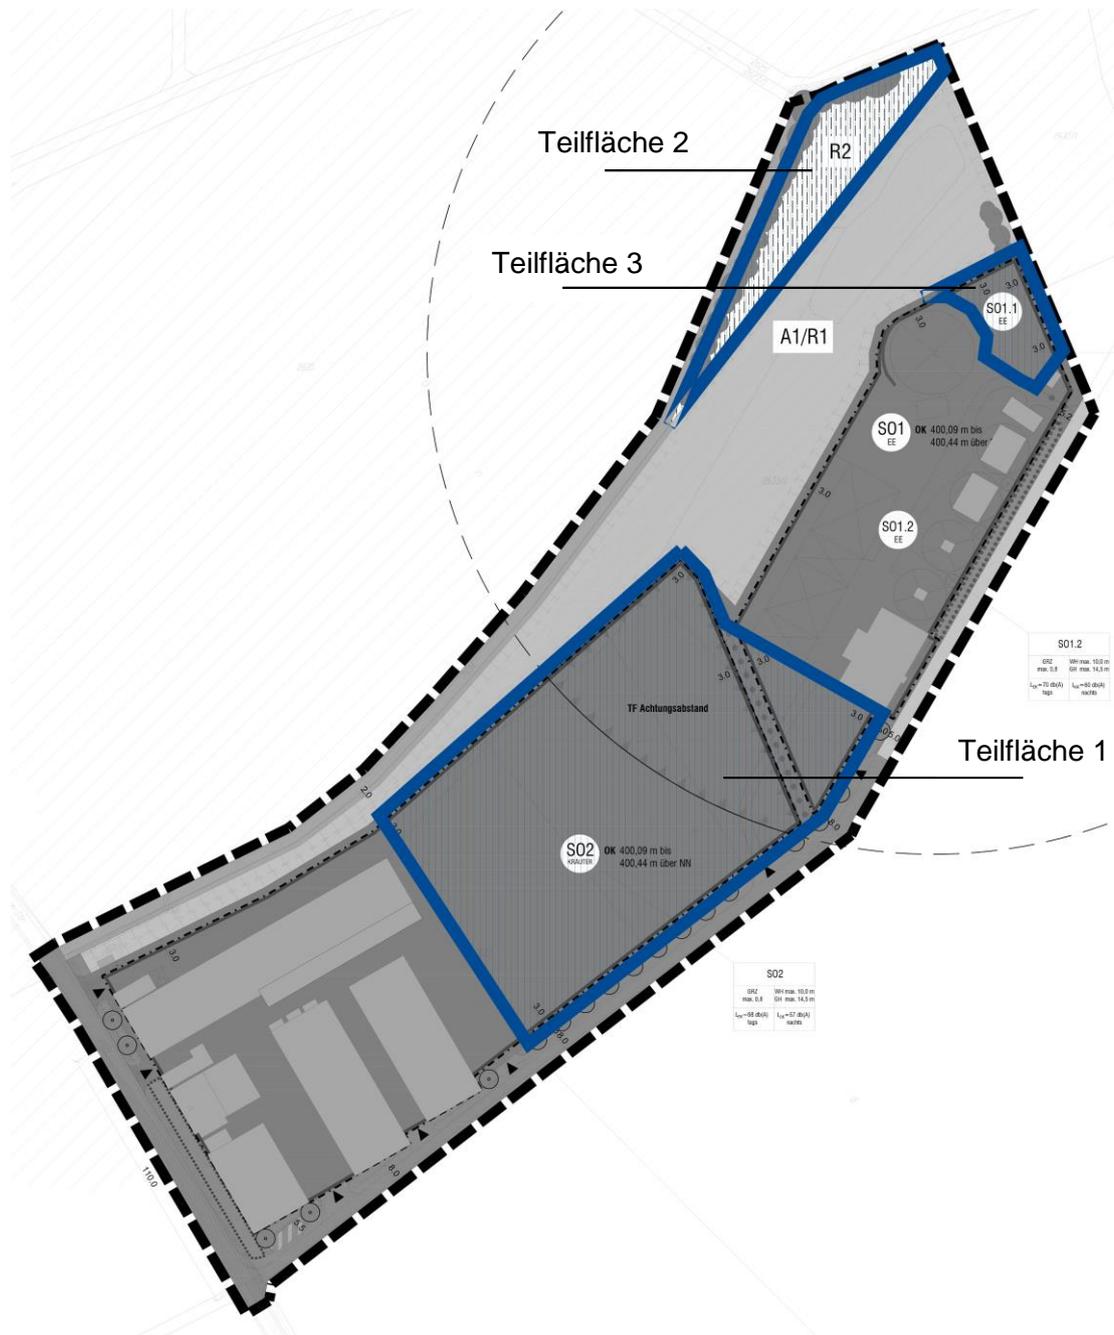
Abgrenzung der teilträumlichen Eingriffsflächen, o.M.
